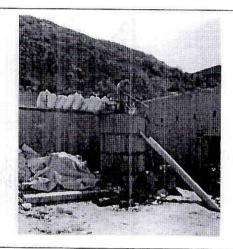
Sistema de Tratamiento Activo – Sector Santa Rita
